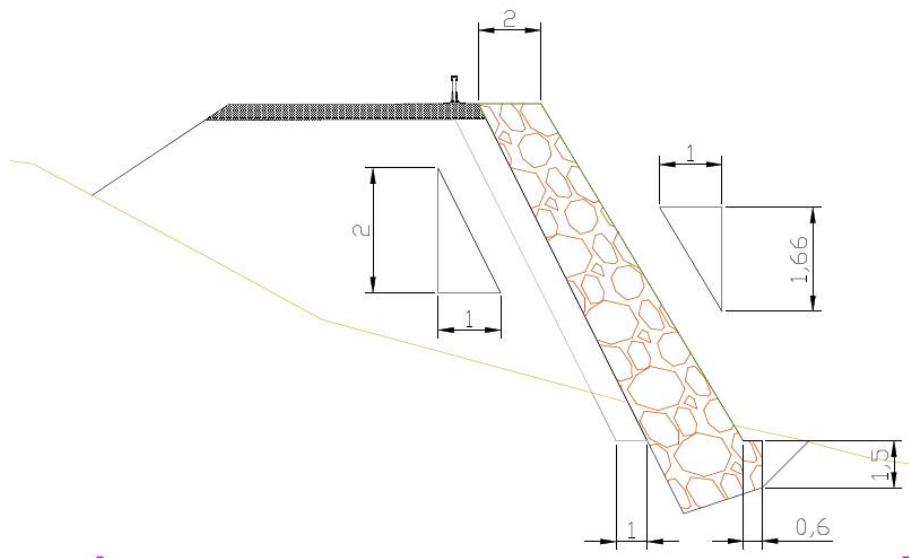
Secció transversal corresponent al mur de la BV-1212 sud.
